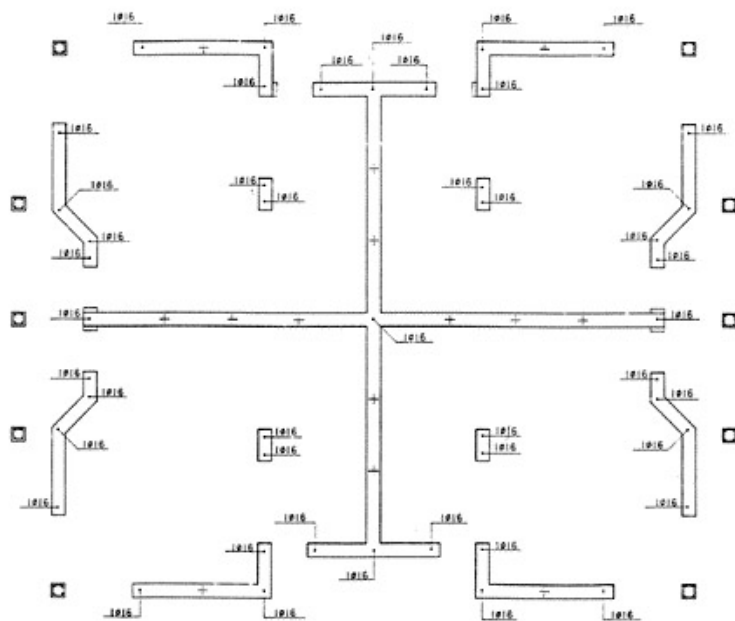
Esempio di disposizione delle armature verticali (pianta).
